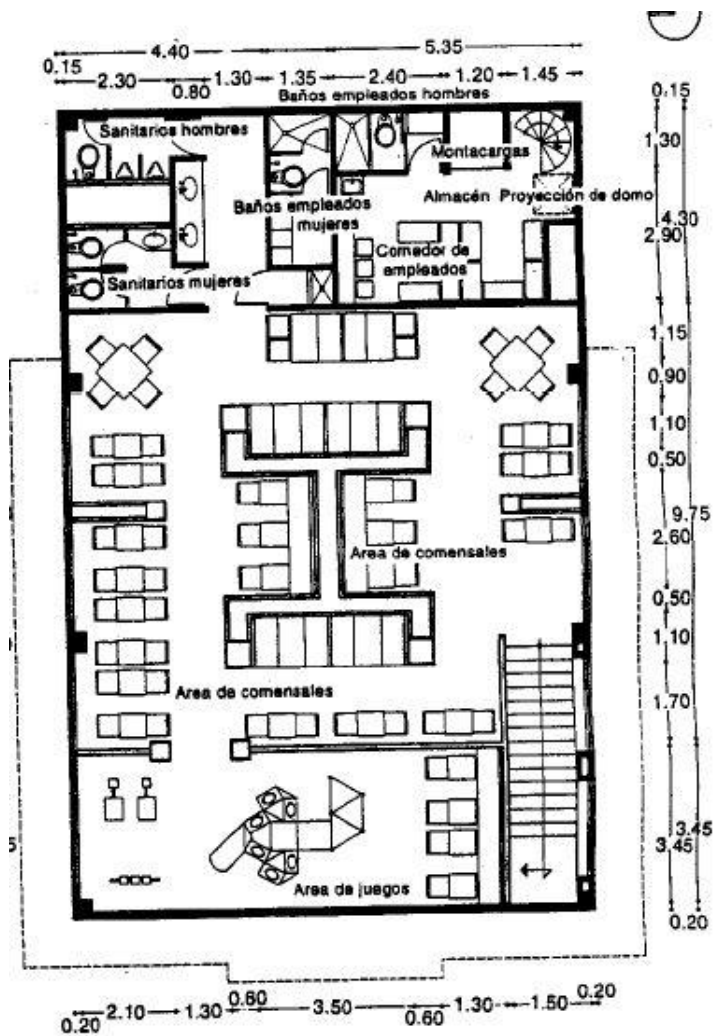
; Ejemplo de planta para una solución de distribución para el restaurante
